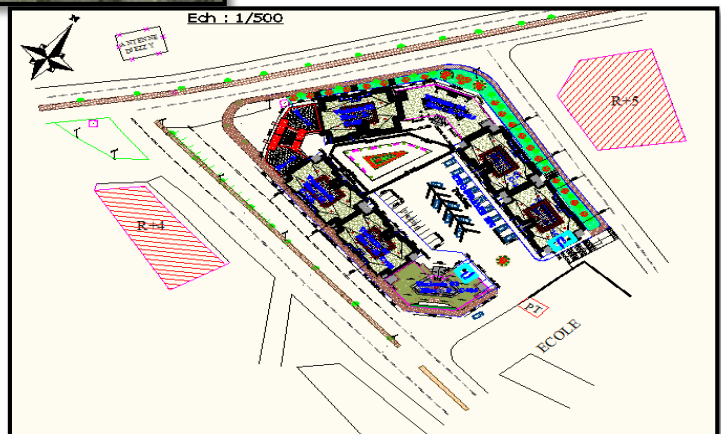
Plan de masse de 140 LSL (voir annexe B)
